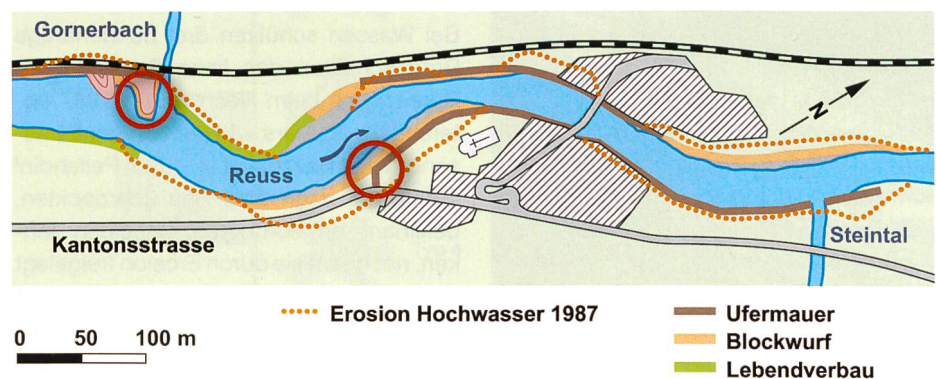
Übersicht des Hochwasserschutzprojekts Gurtellen. Betonelemente sind an den beiden mit Kreisen markierten Stellen eingesetzt.
